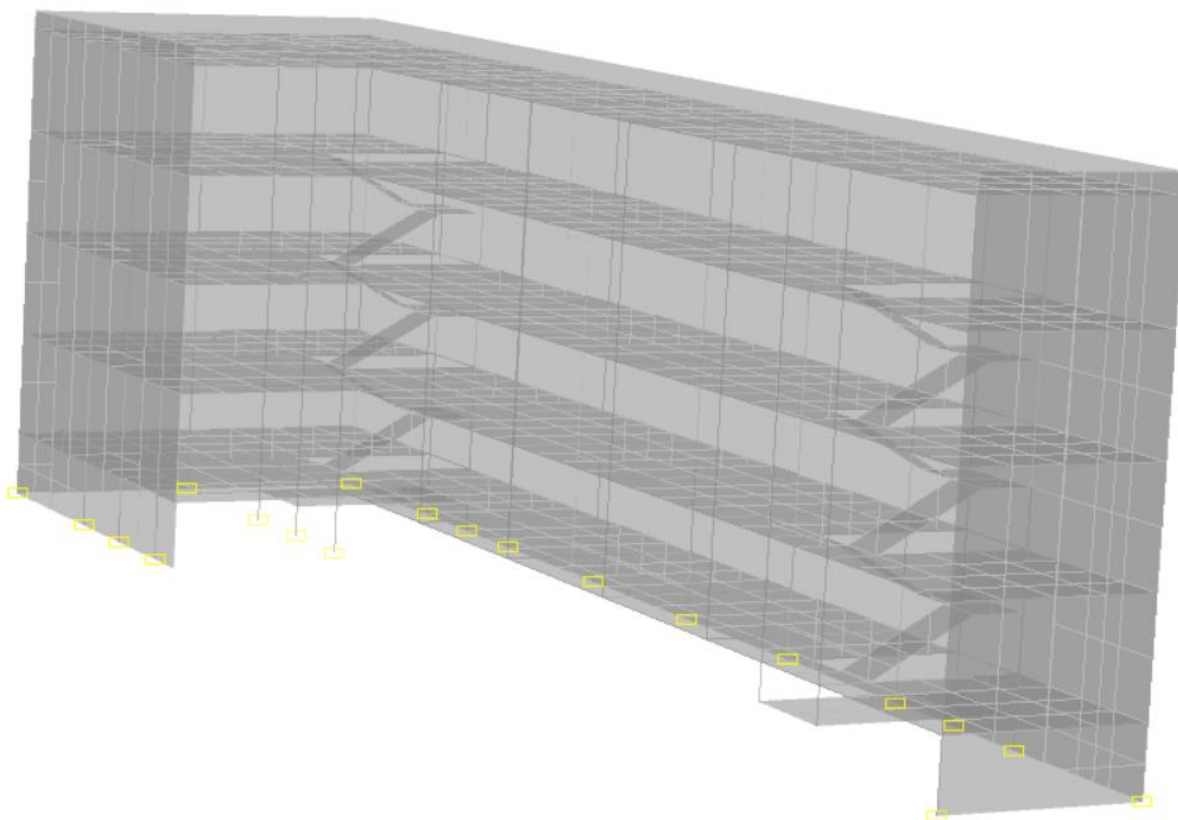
Расчетная схема поперечника здания в пространстве с вырезом.
